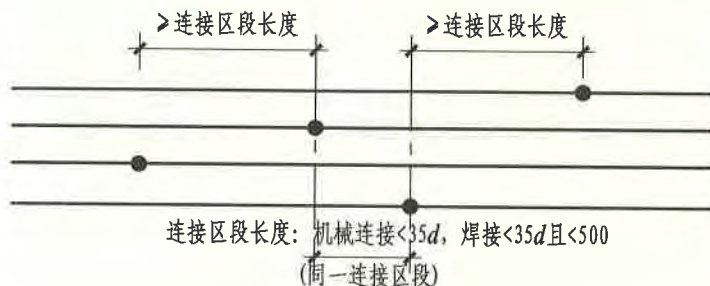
同一连接区段内纵向受拉钢筋机械连接、焊接接头
